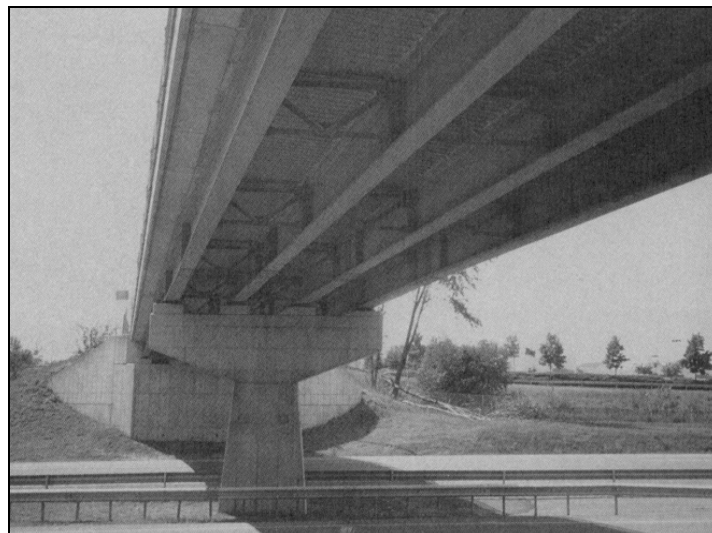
Una pila Cabeza de Martillo soportando una superestructura de losa sobre vigas longitudinales.
